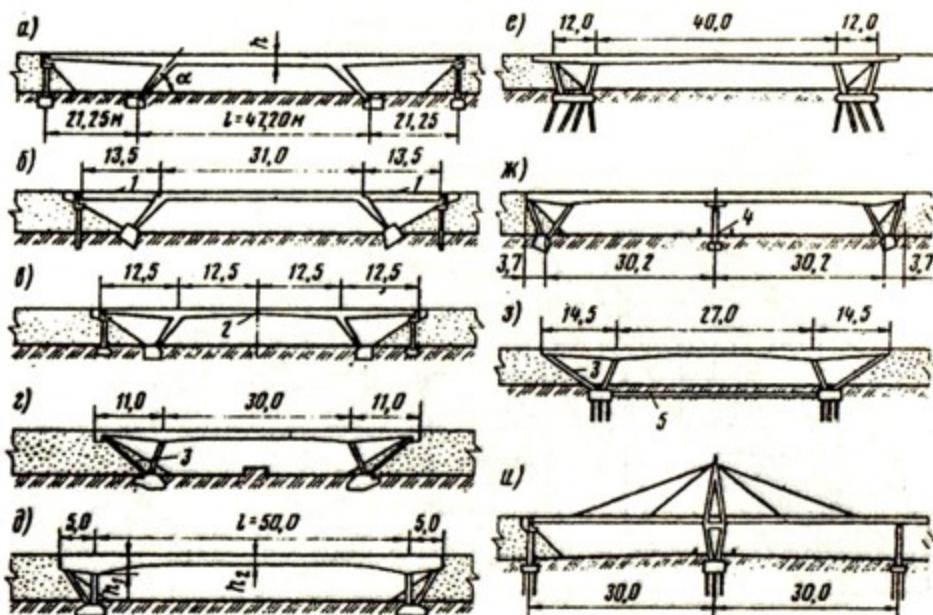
Схемы железобетонных путепроводов рамной и комбинированной систем:
